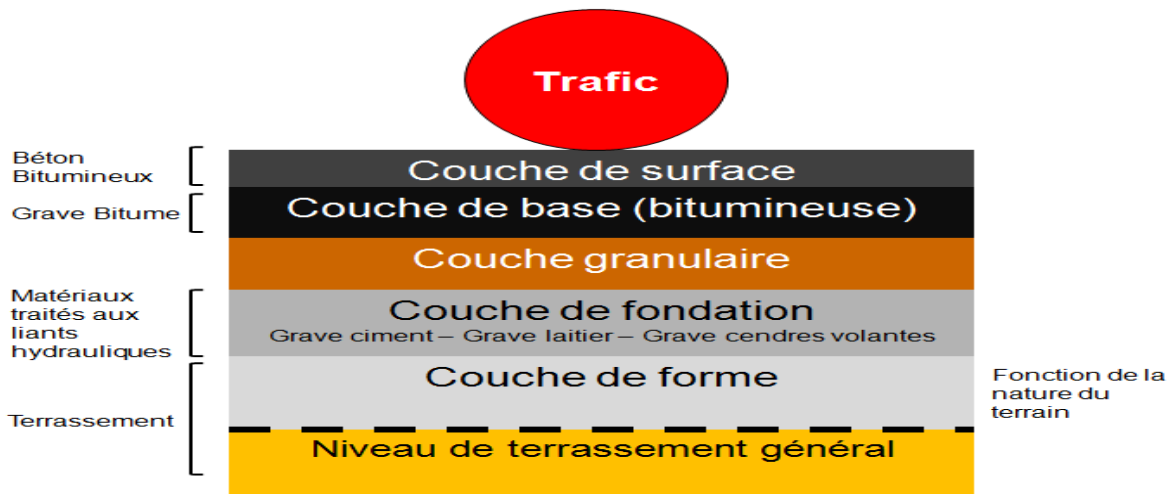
Les couches d'une chaussée à structure inverse [2].
